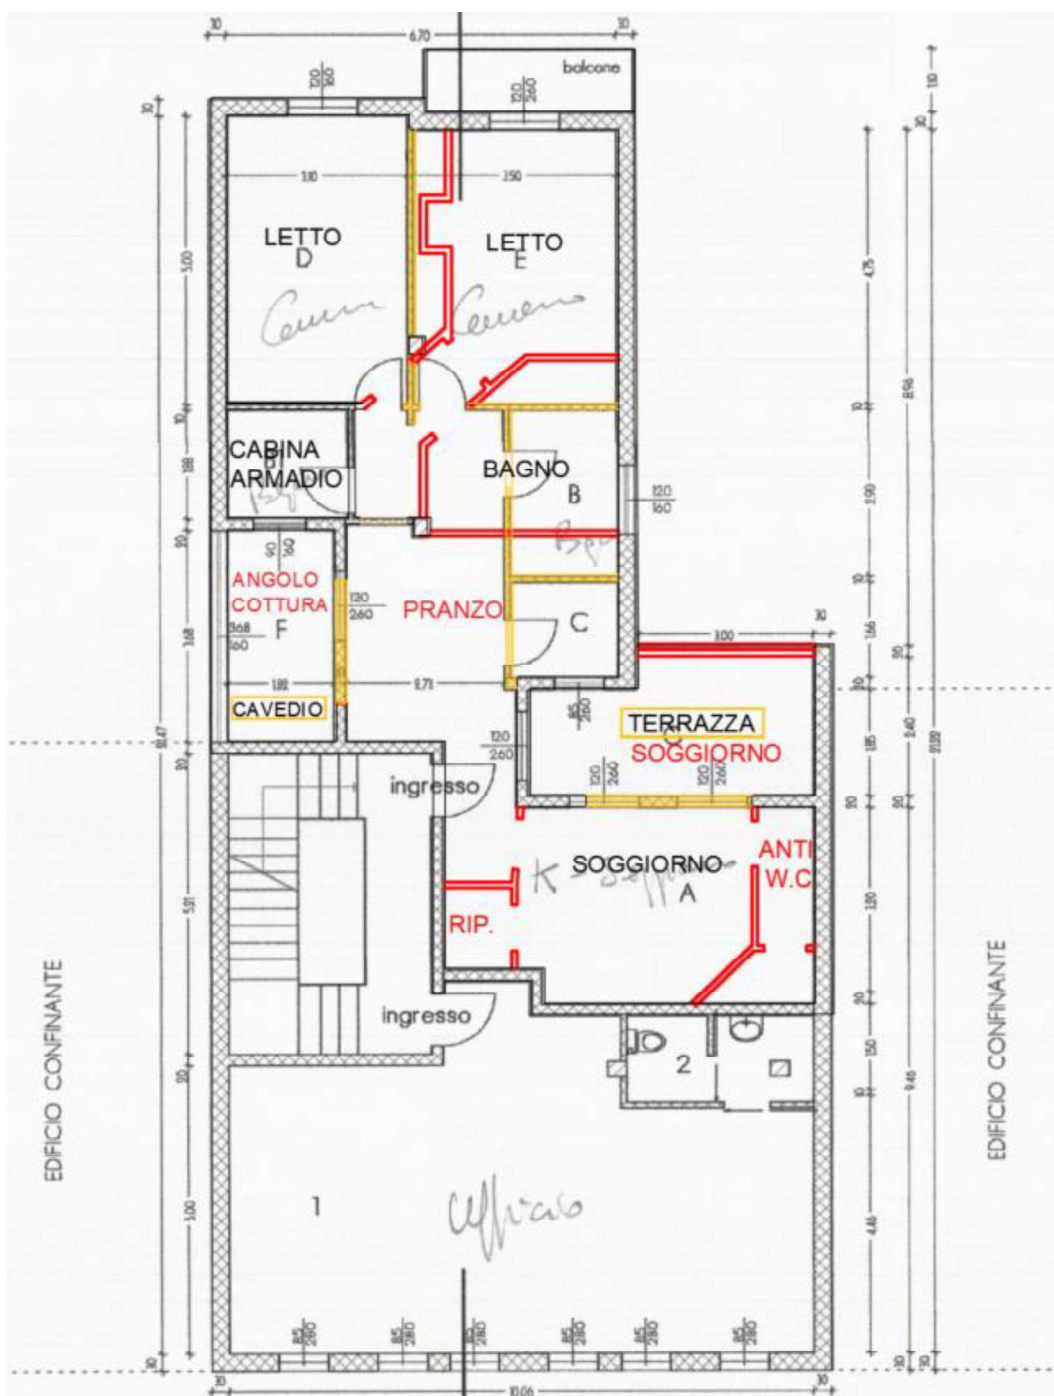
Pianta Piano Primo – indicazione delle principali difformità rilevate rispetto allo stato legittimato, in rosso le opere costruite in giallo quelle demolite- L'ufficio è di altre ragioni- Fuori Scala
